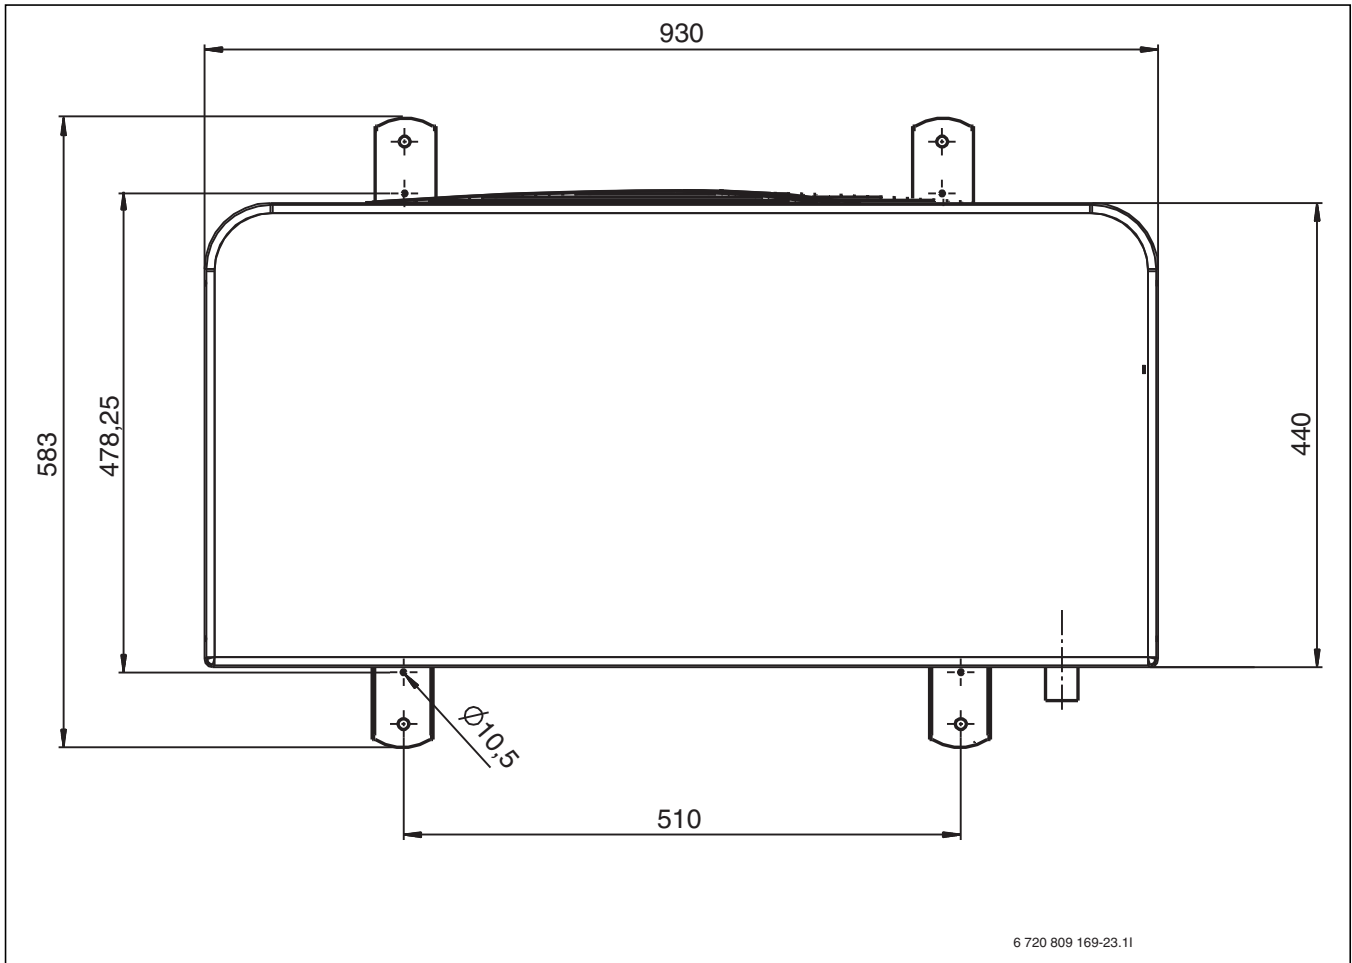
Abmessungen der Außeneinheit 6/8, Draufsicht
